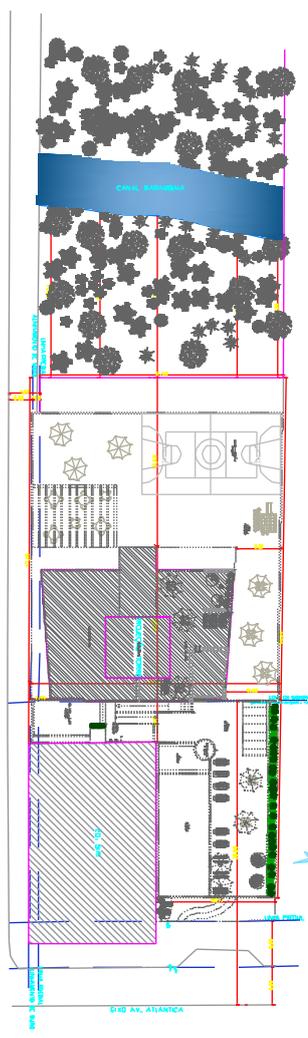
Detalhe da planta baixa de implantação do empreendimento BOREAL TOWER.
